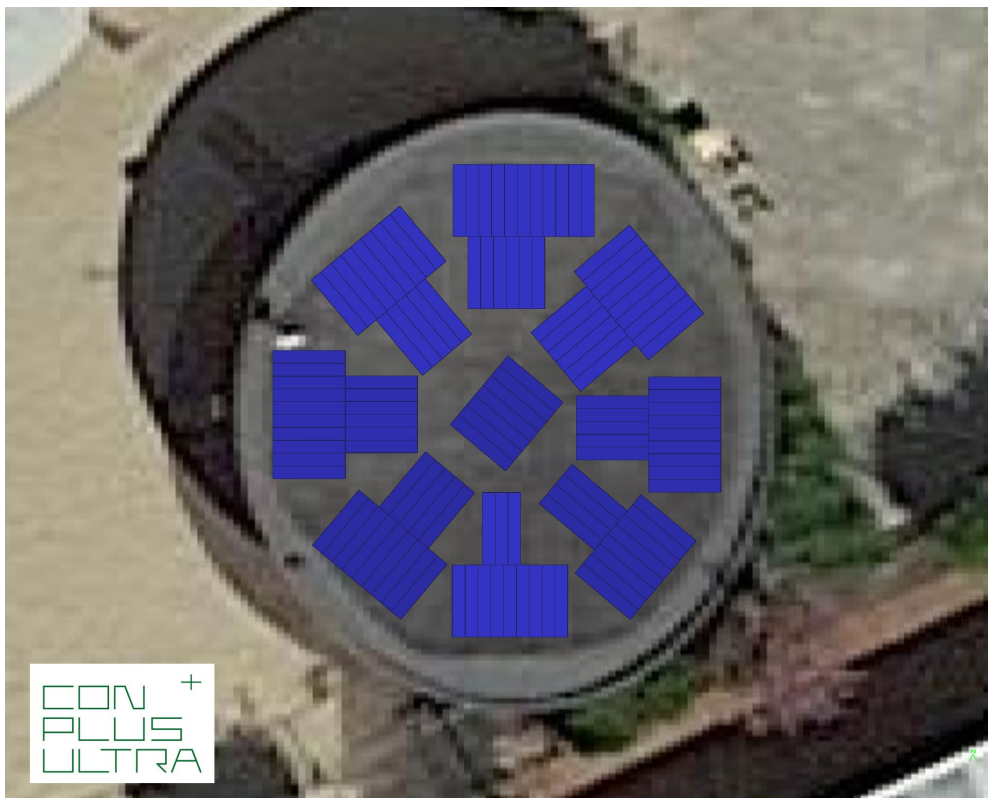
Holz-, Strahlkonstruktion mit Bitumendach
